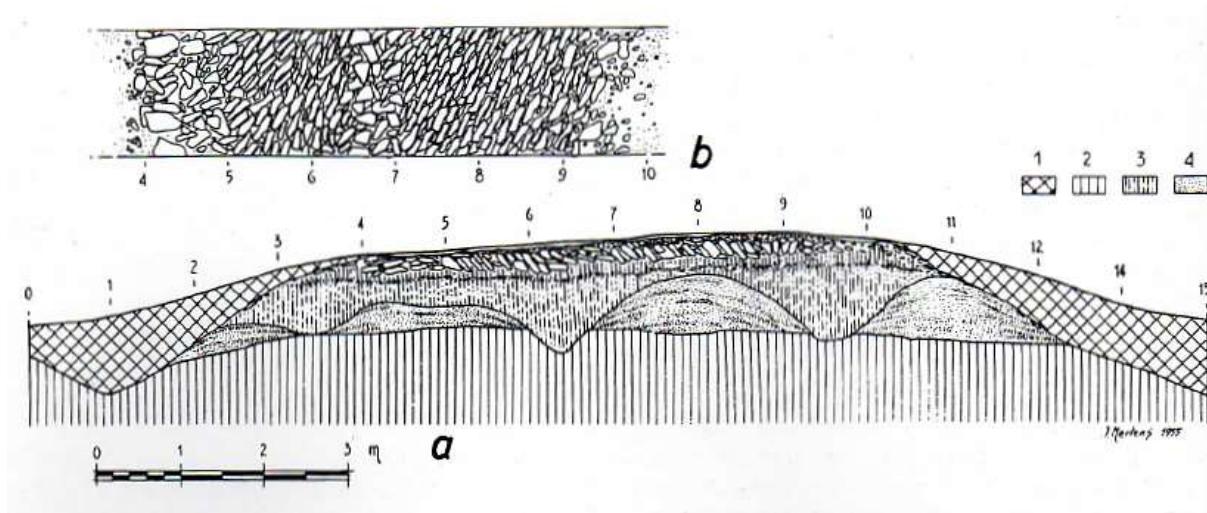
Coupe de la chaussée à Florenville. a : coupe – b : aspect de la disposition de l'assise.
